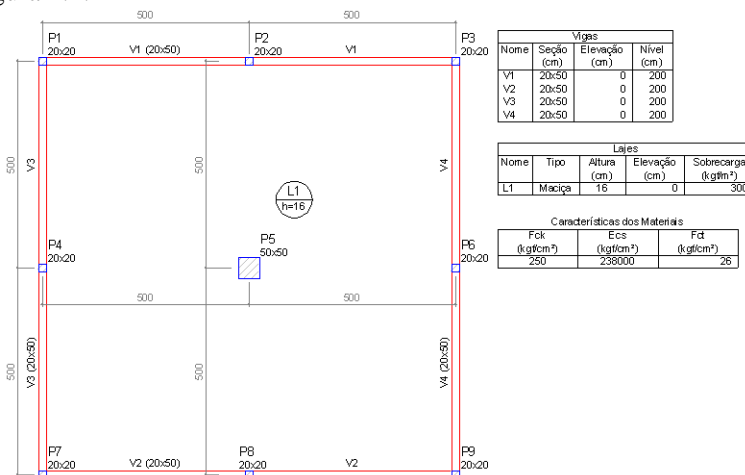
Geometria do pavimento (Puel, 2009).
